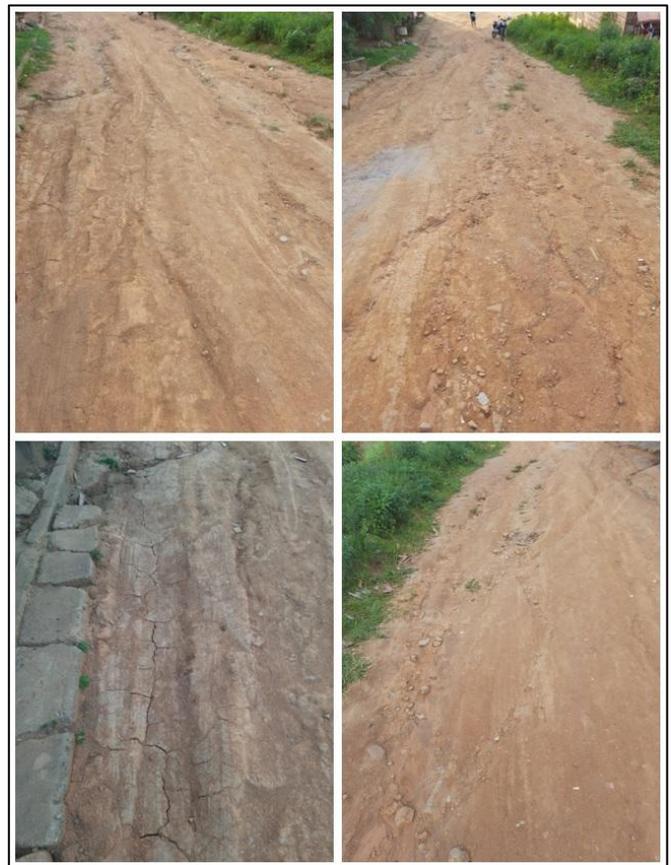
Ponto 04, trincas e ravinas na Estrada.
